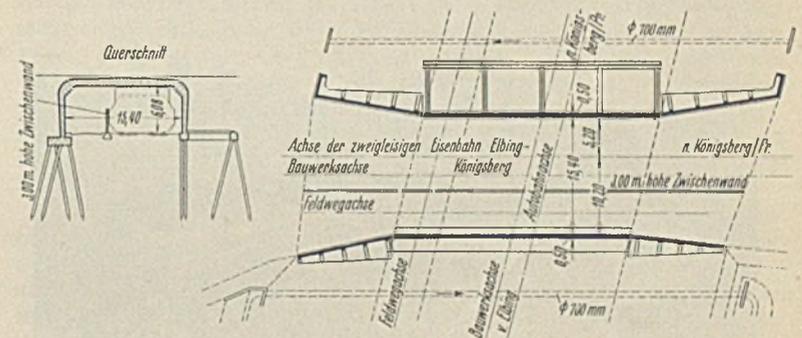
Bauwerk 8, Eisenbahn- und Feldwegunterführung in km 12,6 + 30, Querschnitt und Grundriß.
